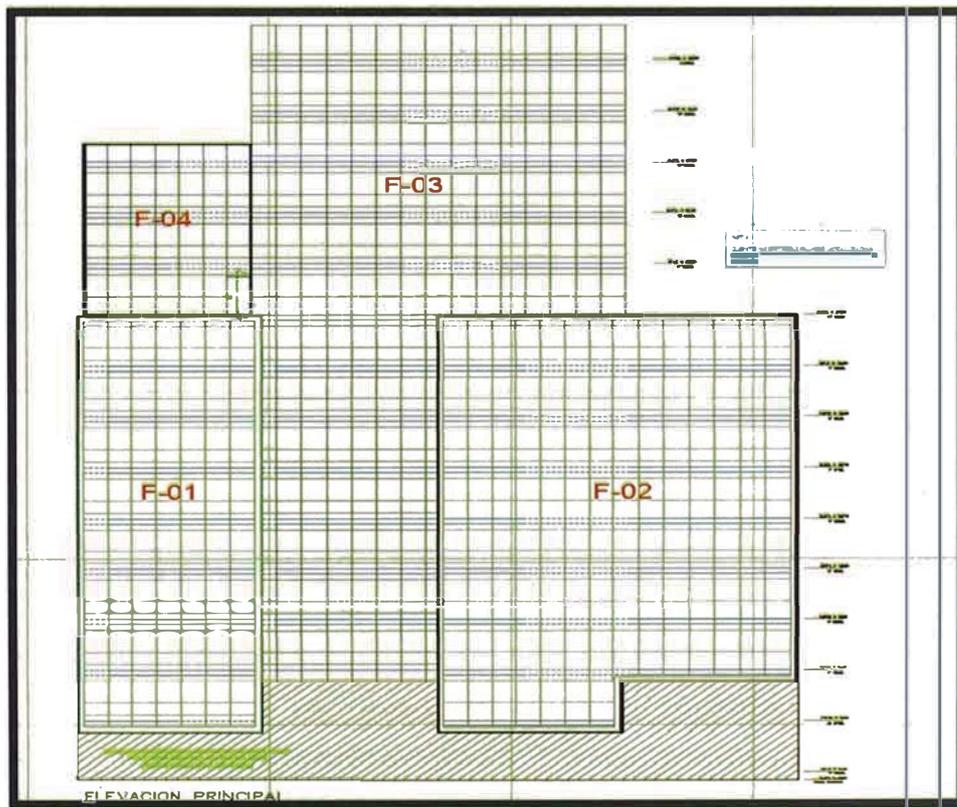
Vista frontal del edificio- Elevación principal- Calle Martín de Murua.
